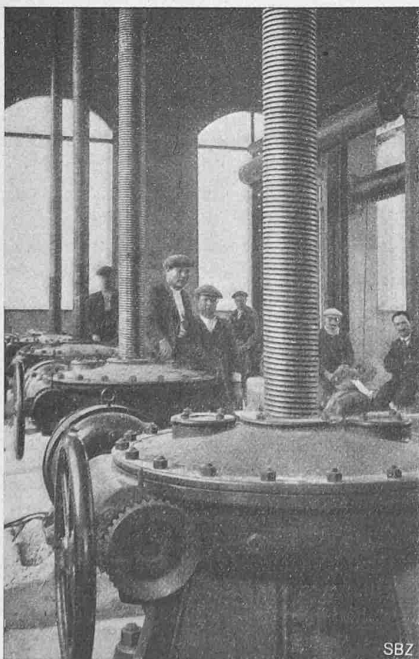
Schützen-Hubspindeln mit Motor- und Hand-Antrieb.
